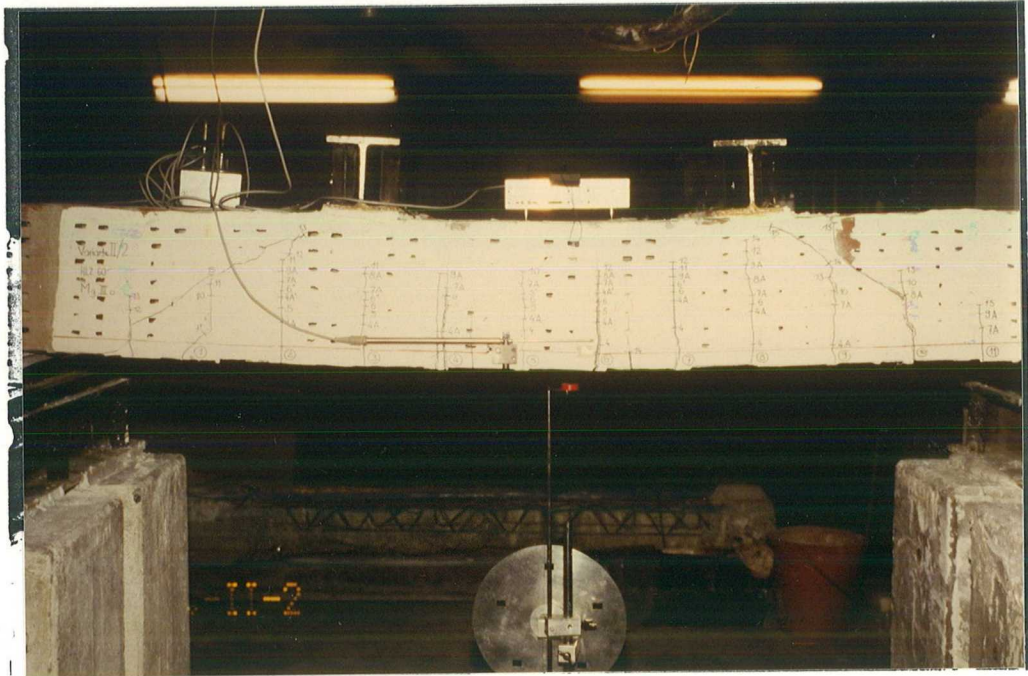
Versuch II/2 nach dem Versagen durch Biegebruch;
